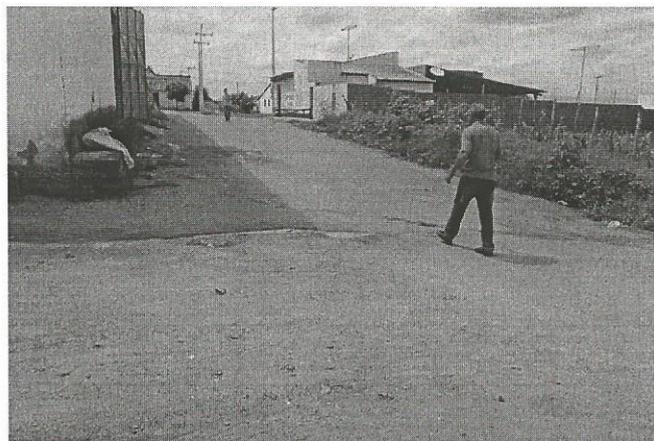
RUA S.D.O. 03 (TRECHO 02)
